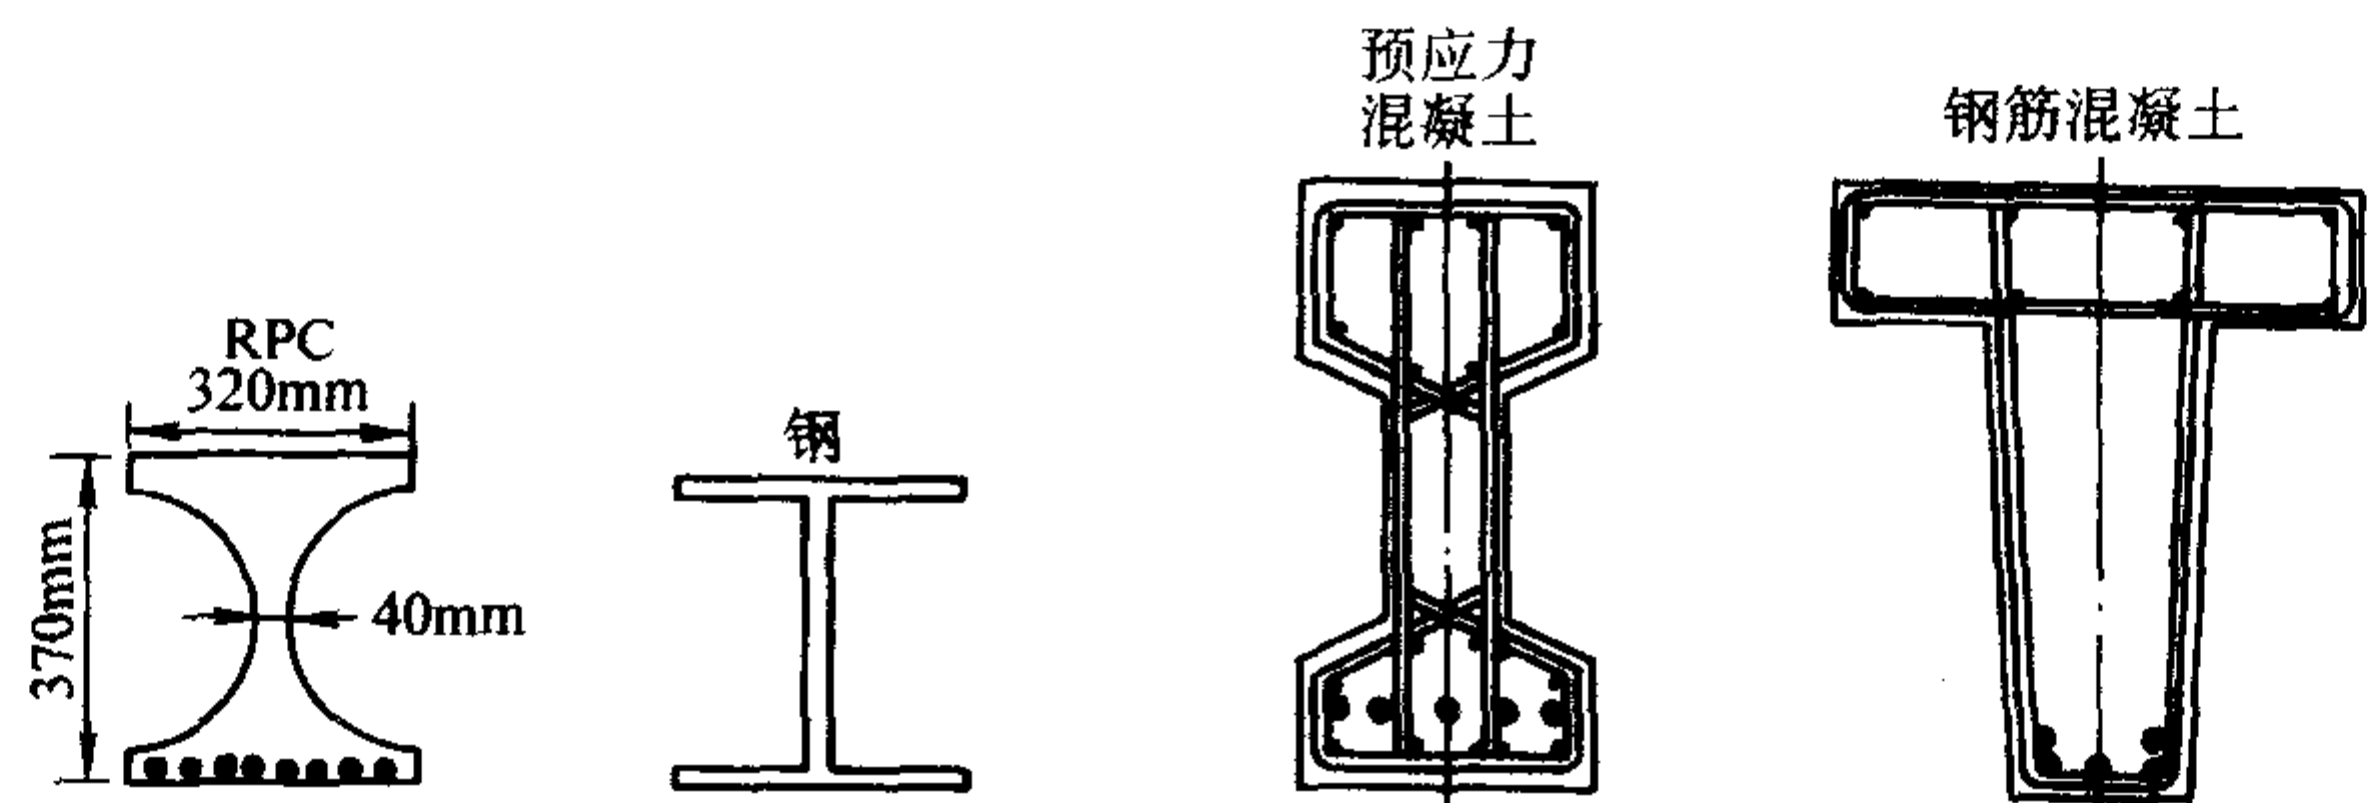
用 RPC、钢、顶应力混凝土与钢筋混凝土制成的工字形梁的横断面
